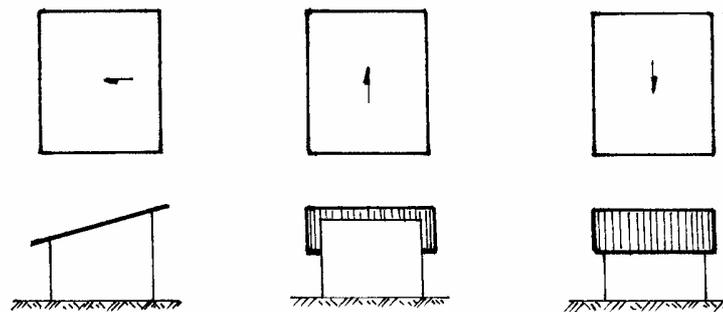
Telhados com apenas 1 água. Fonte: FACENS, 2001.
